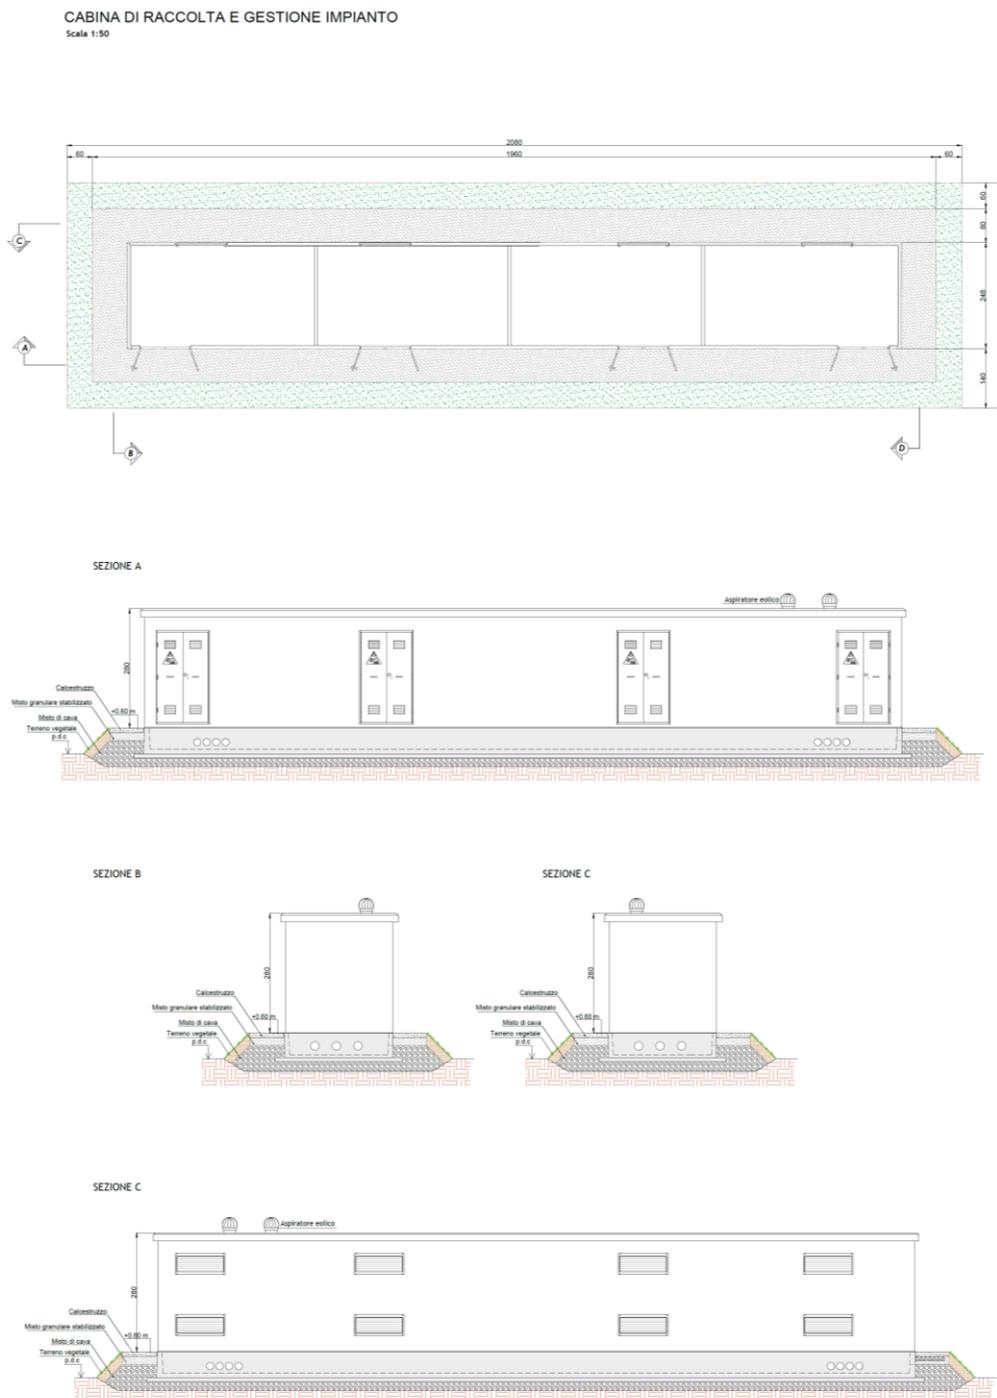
Planimetria e prospetto della Cabina di Raccolta R1
